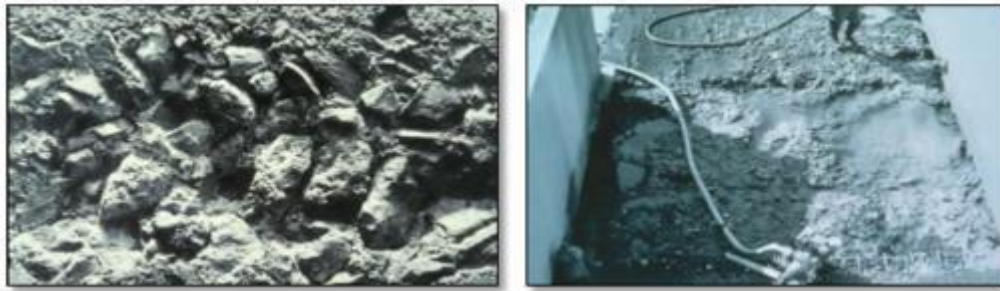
Picaduras o Cavitación a estructuras de concreto.
